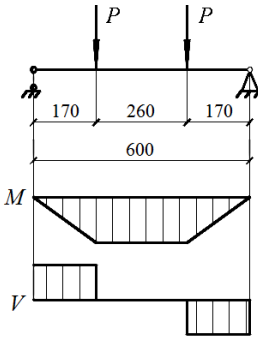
Расчетная схема балки и эпюры внутренних усилий
